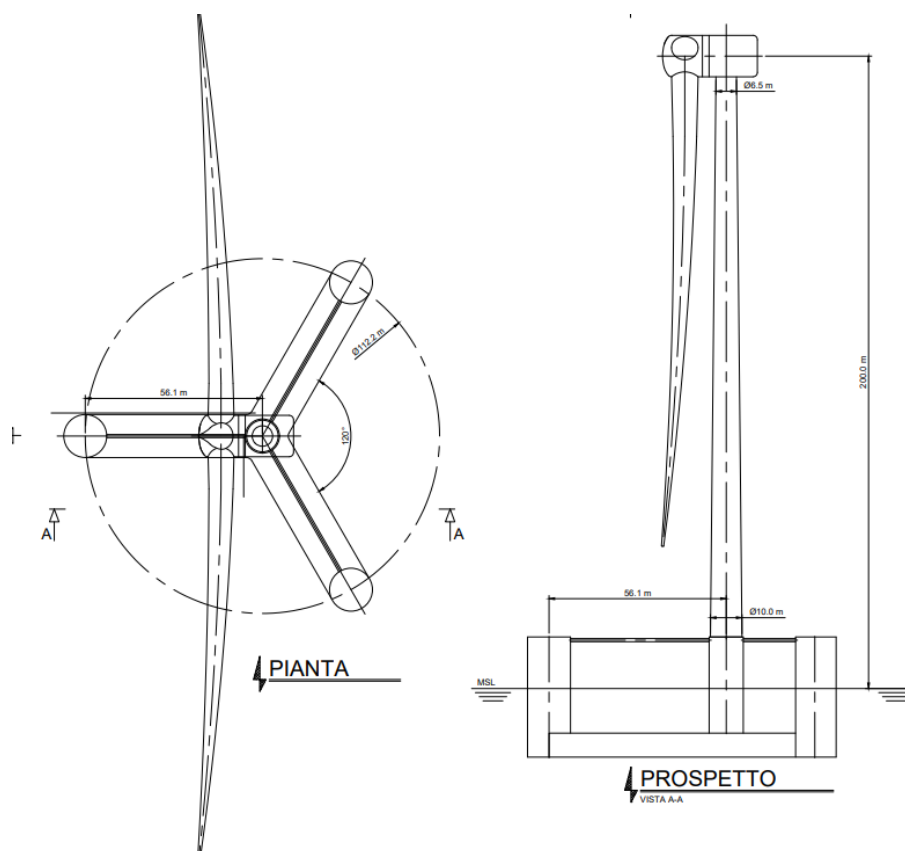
Prospetto dell'insieme fondazione-turbina<sup>2</sup>.
